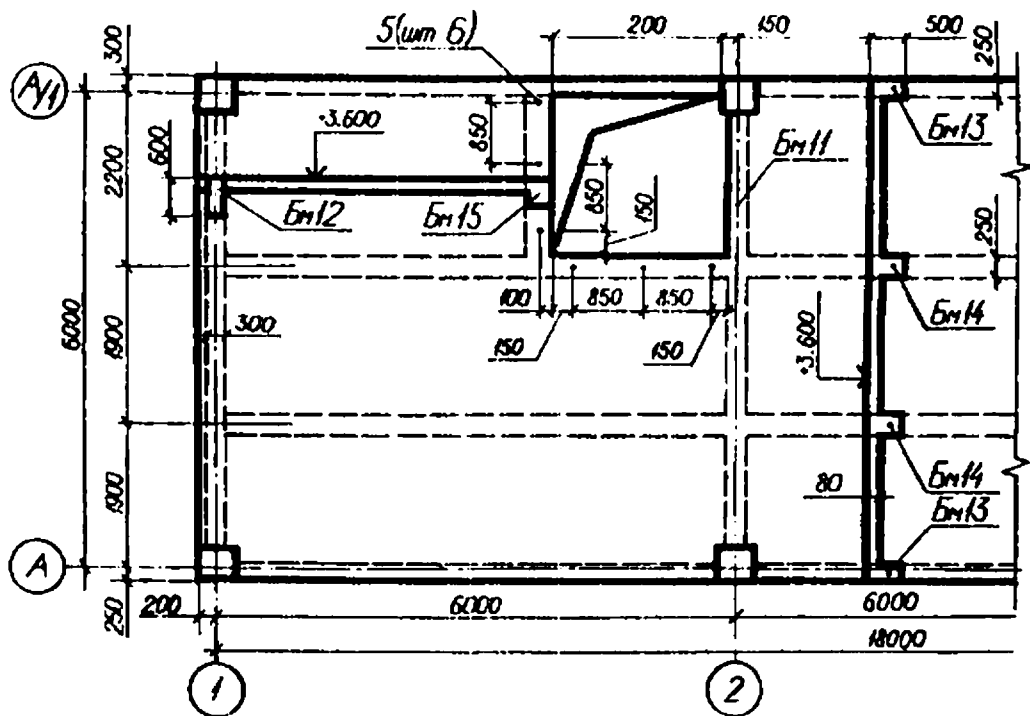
Пример схемы расположения монолитного перекрытия
